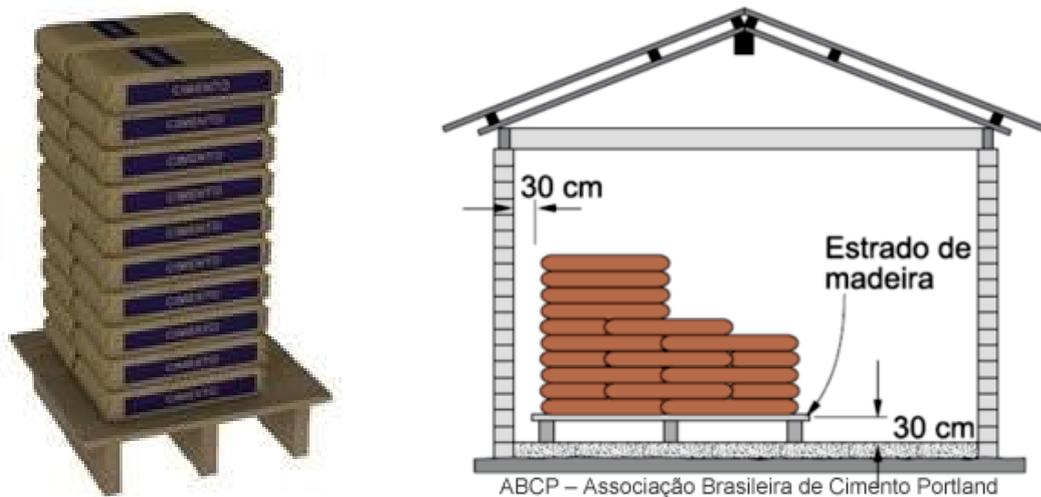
Acesso ao deposito Figura 54 - Pilha de Cimento
